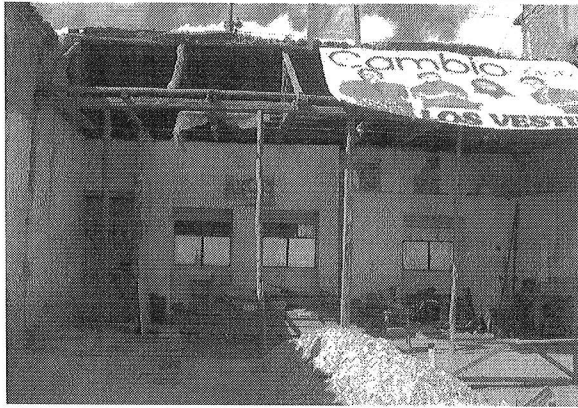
Cara interna del muro de fachada; elementos de madera del cobertizo de la zona frontal.
